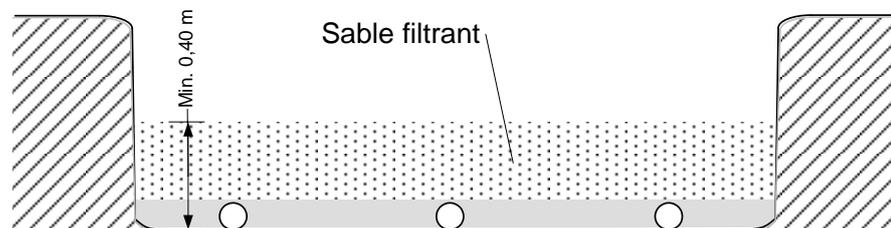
Vue en coupe du bassin avec la couche de sable filtrant
